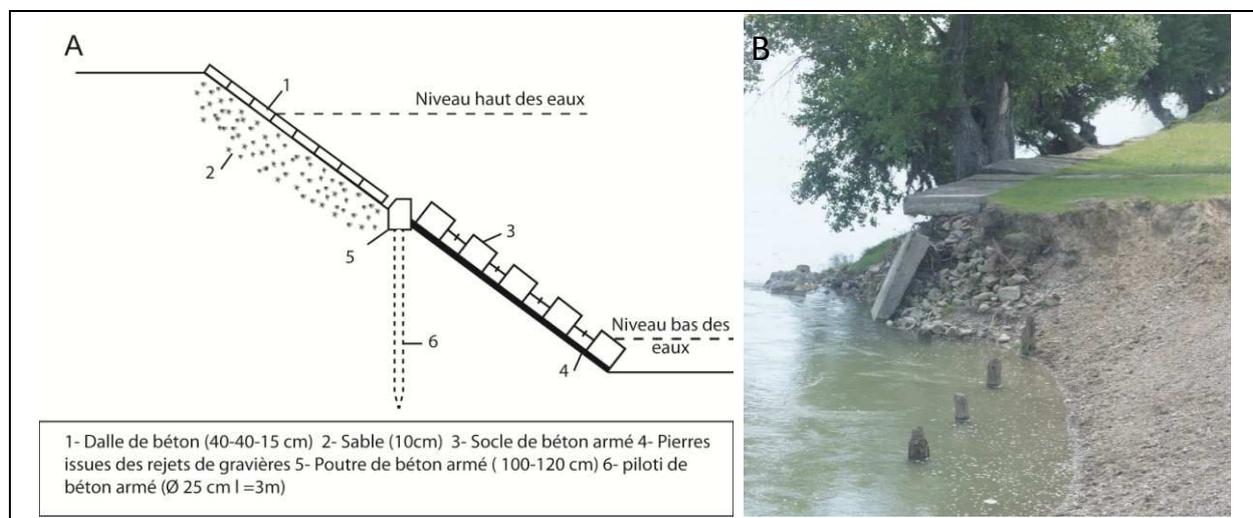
30: A – Schéma de travaux de protection des berges (traduit d'après Manoliu, 1973). B – Ouvrages de protection des berges sur le Siret inférieur entre Biliștei et Suraia (F. Salit, juin 2012)
